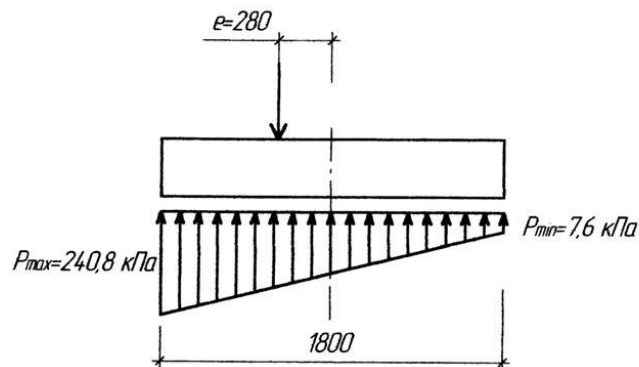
Епюра тиску під підшовою фундаменту під колону крайнього ряду
